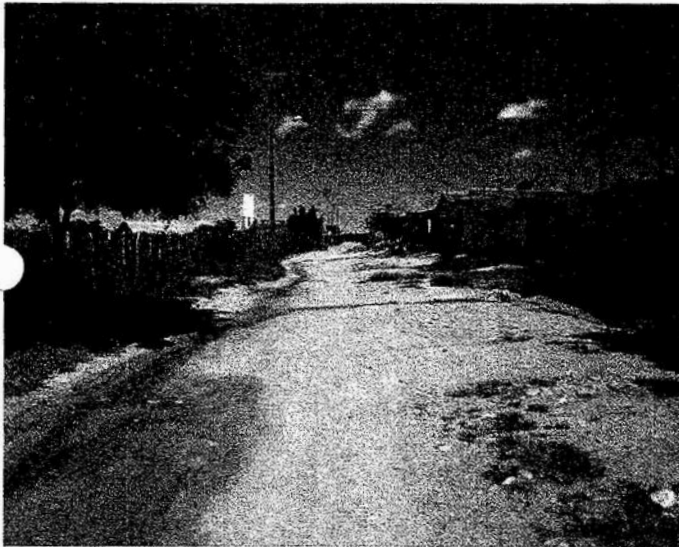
A 04 – RUAS DO BAIRRO SANTA INÊS.
